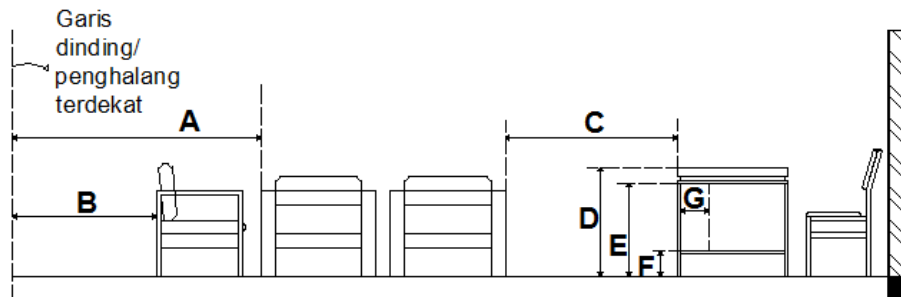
Gambar LI: Denah, sirkulasi dan potongan ruang kepala jurusan
